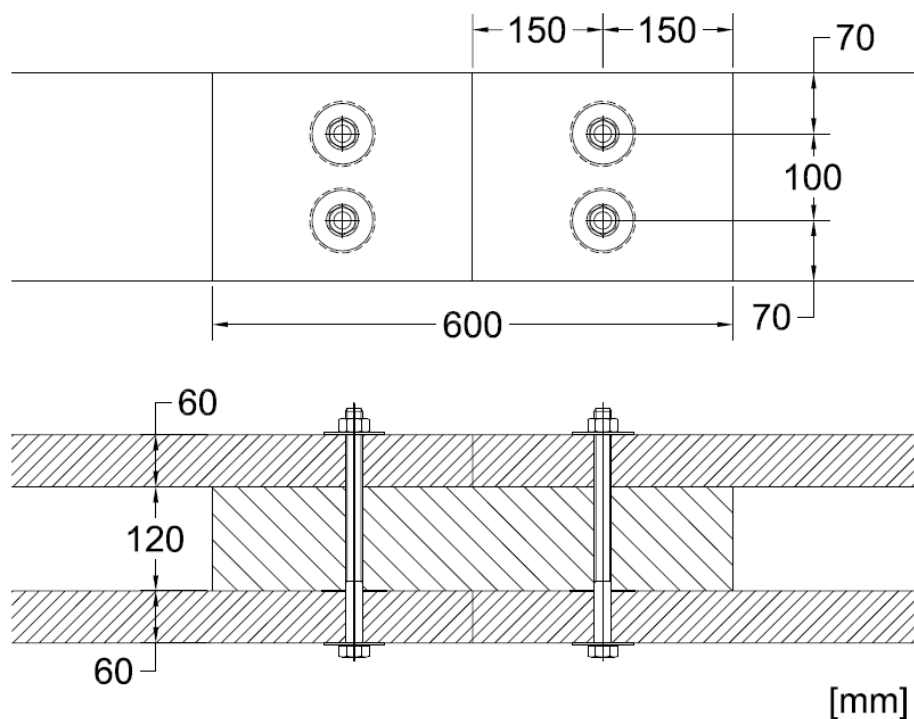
Ligação emenda da linha (alçado e corte).
